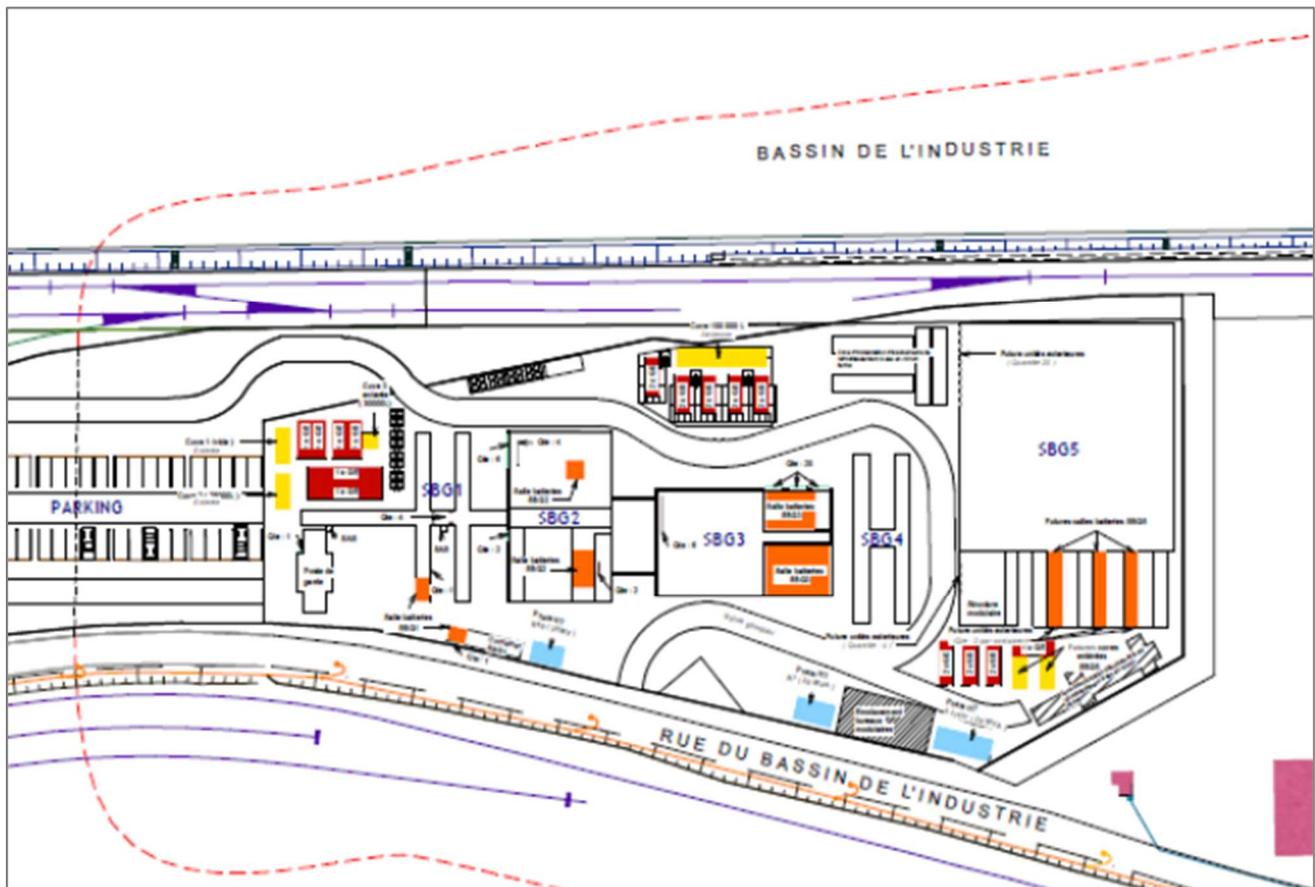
Plan du site (source OVH) (Le même plan à une échelle plus grande figure en annexe 2)
